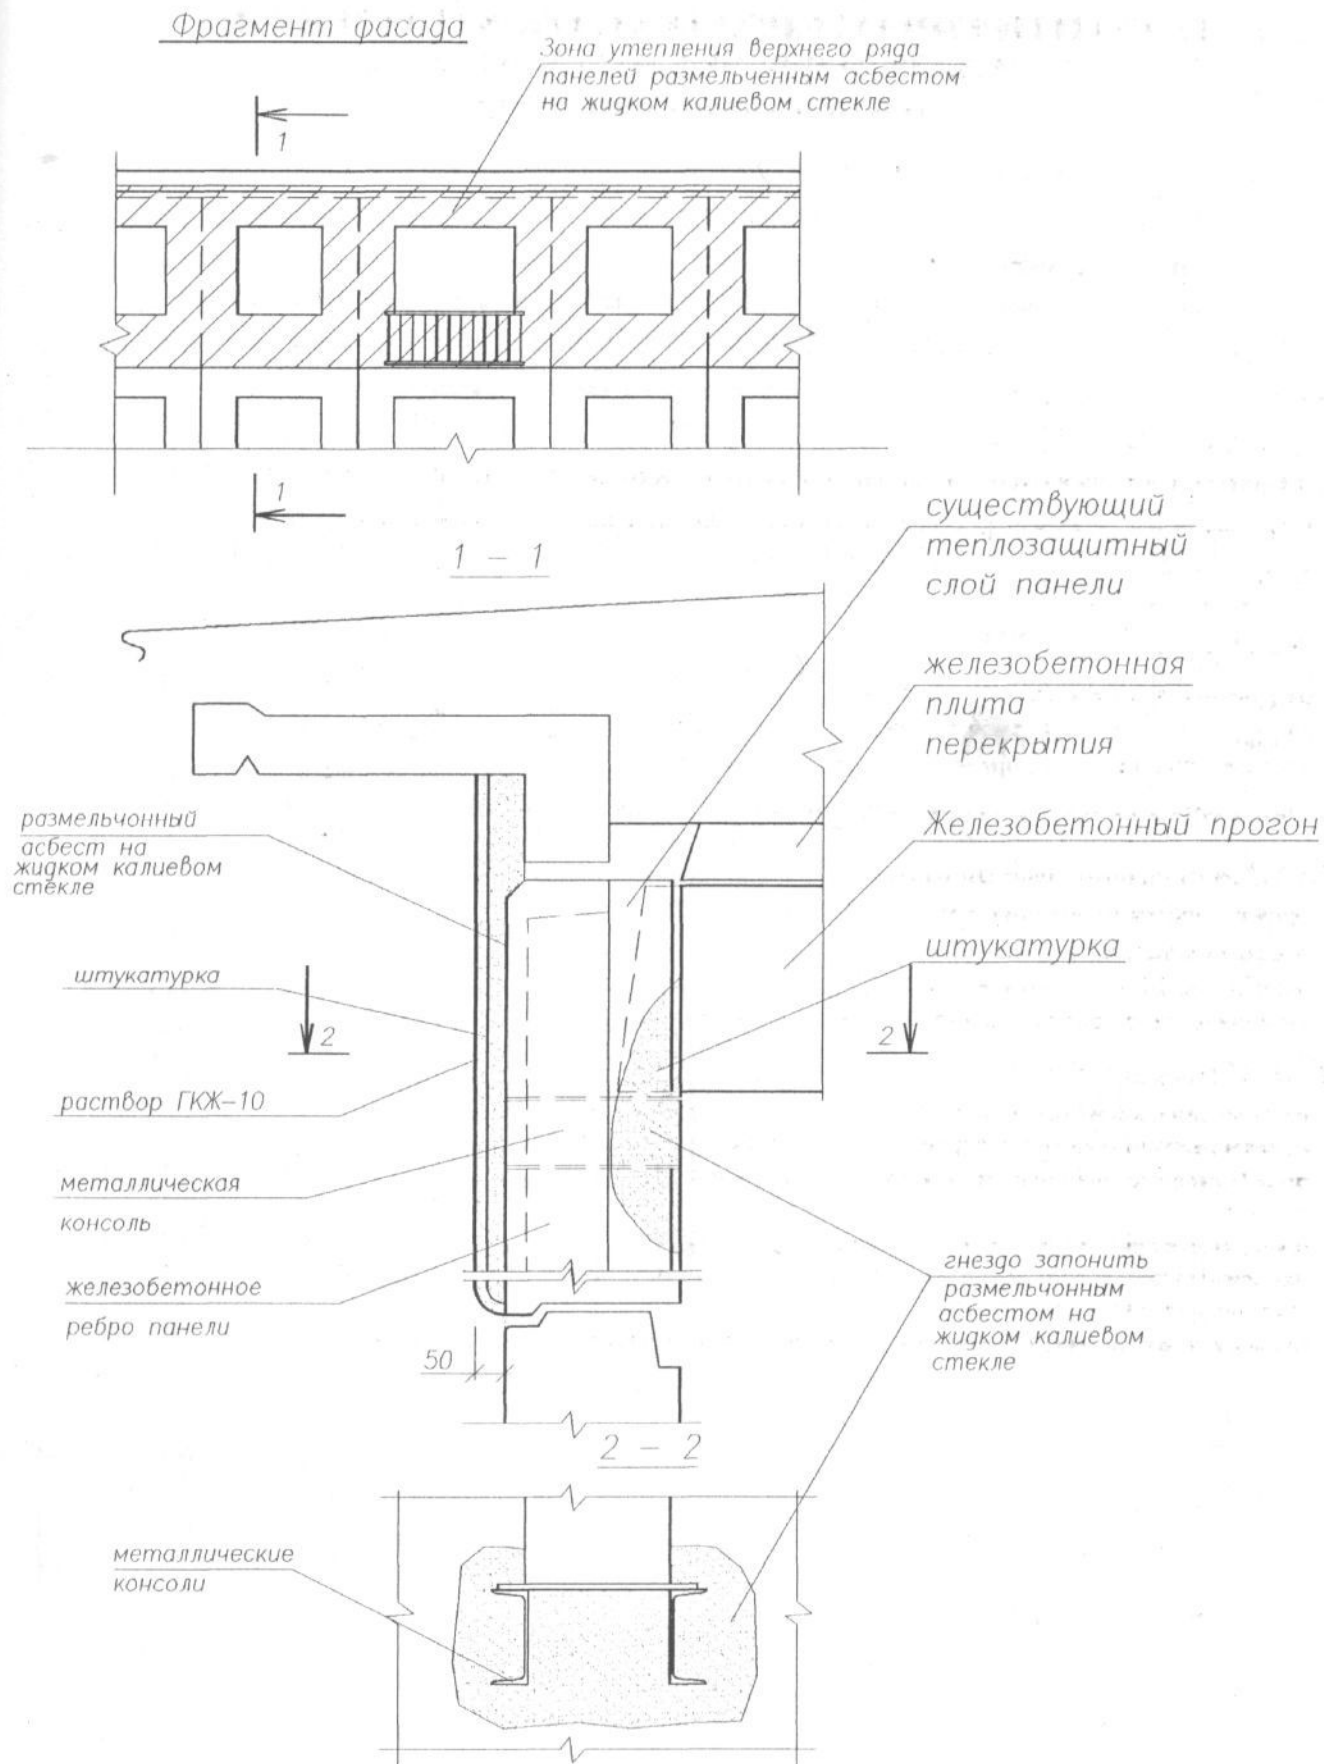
Утепление переохлажденных зон со стороны помещения
